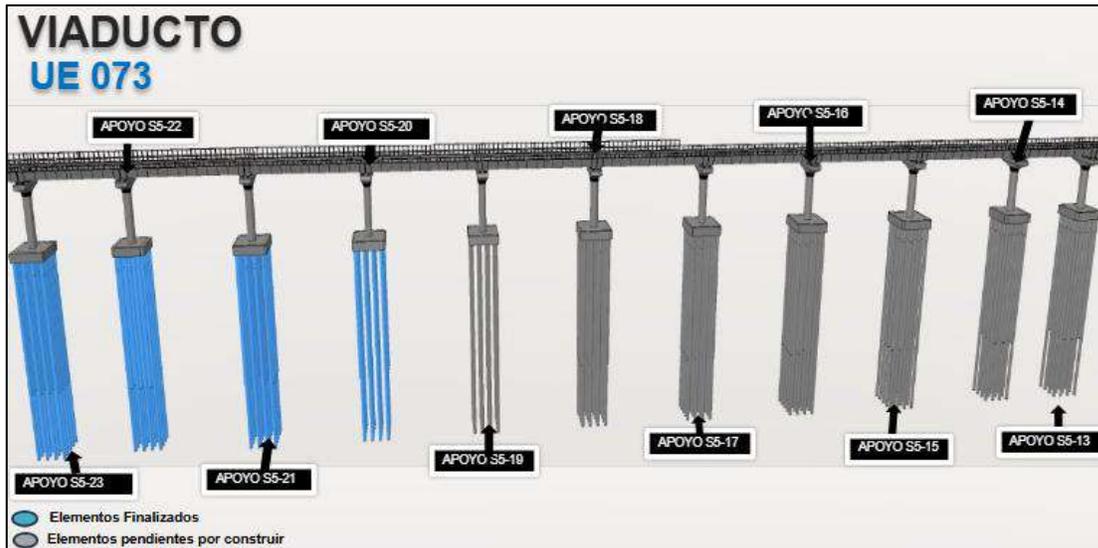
Apoyos comprendidos en UE 073.
